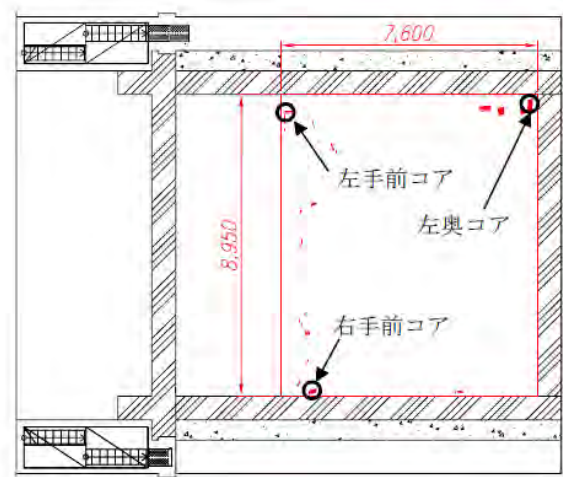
ひび割れ深さ確認コア削孔位置
